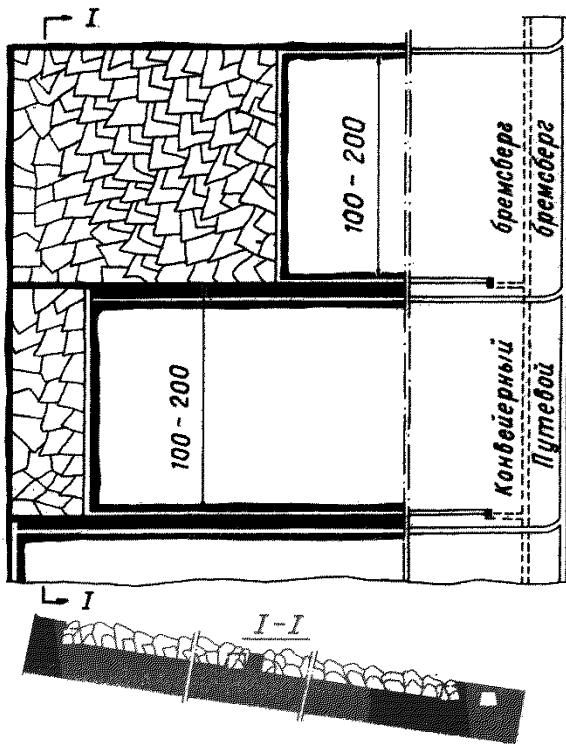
Схема разработки наклонными слоями с последовательной выемкой слоев
